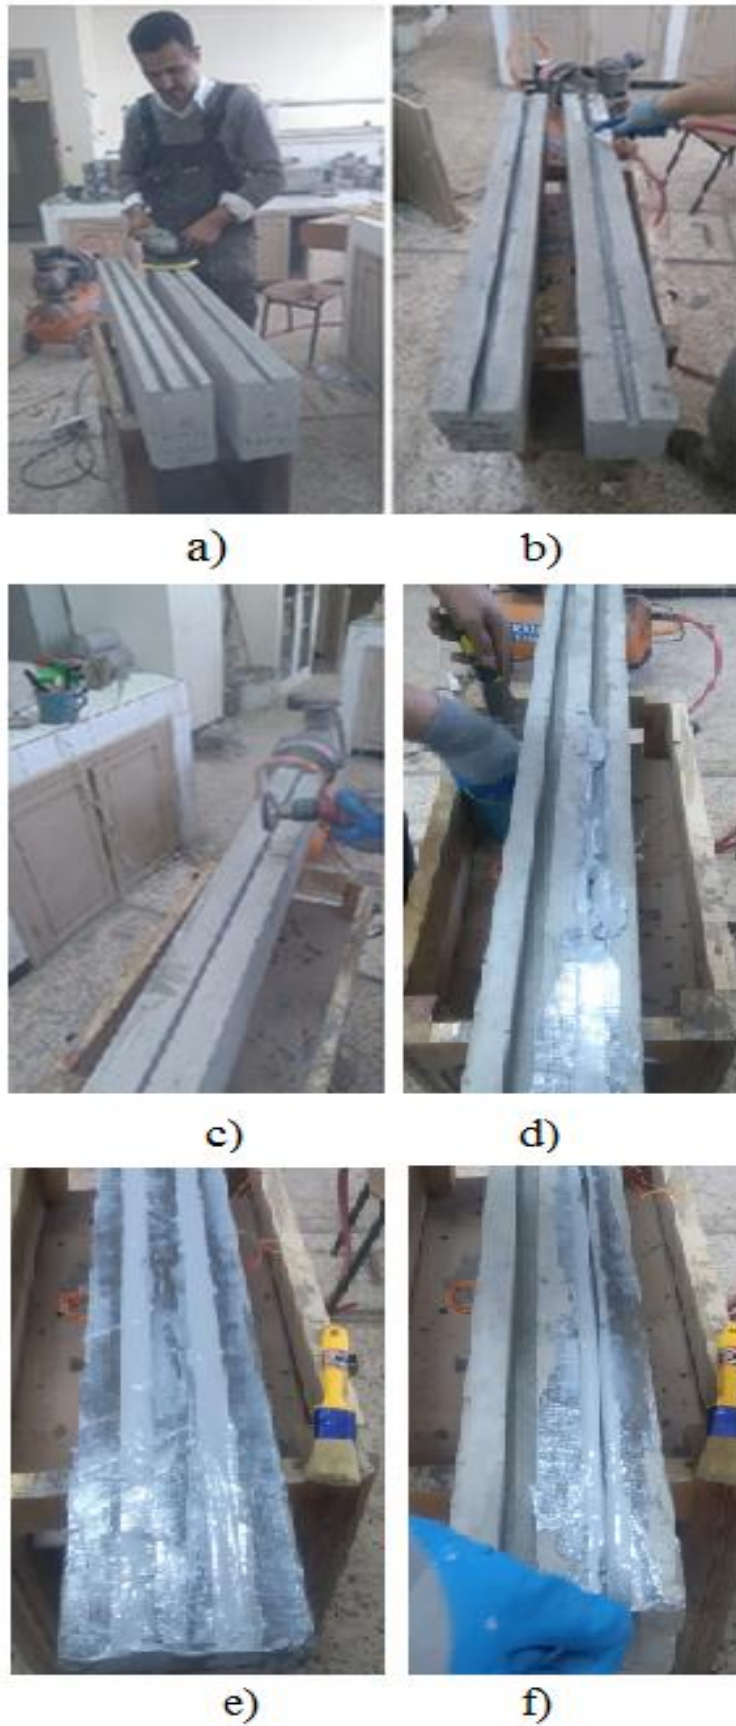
8. Étapes de l'installation du PRFC sur les poutres selon NSM.
